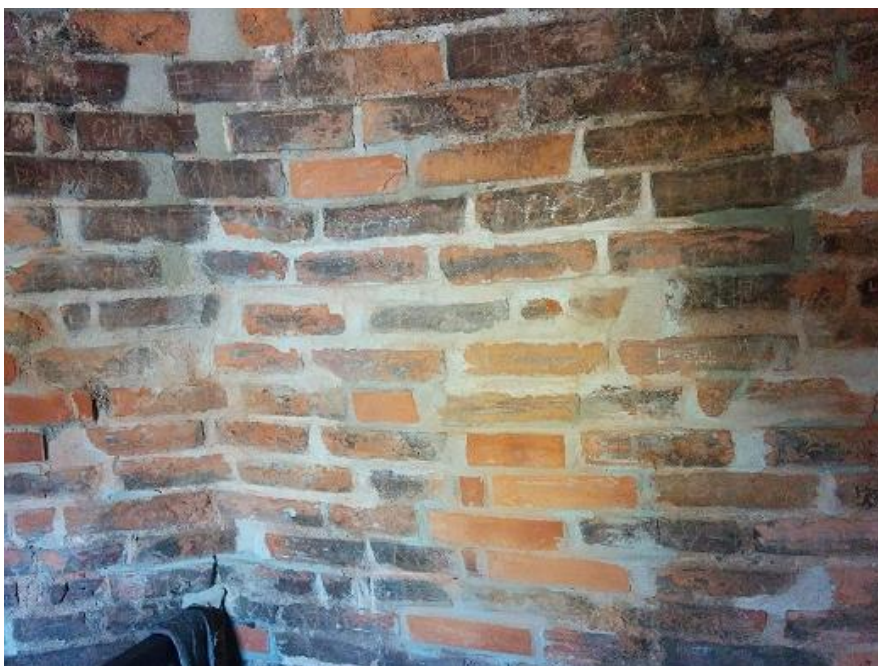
Ceglany mur zwieńczenia wieży z cementową spoiną
